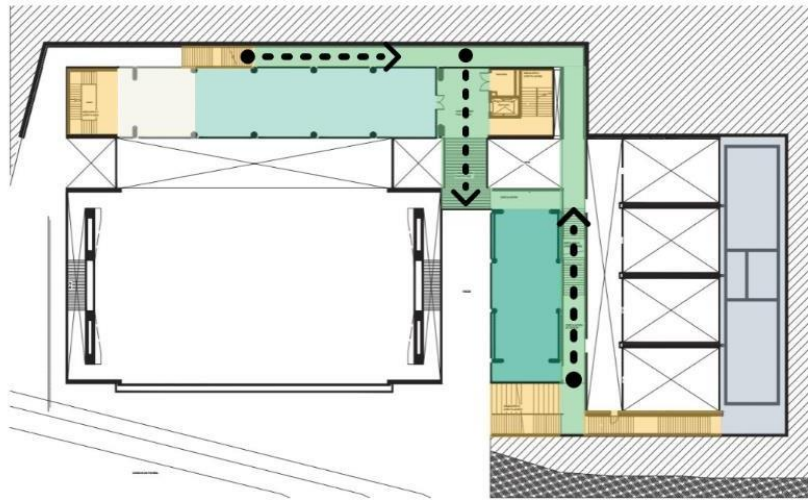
Segunda planta - Centro deportivo Univ. De los Andes
